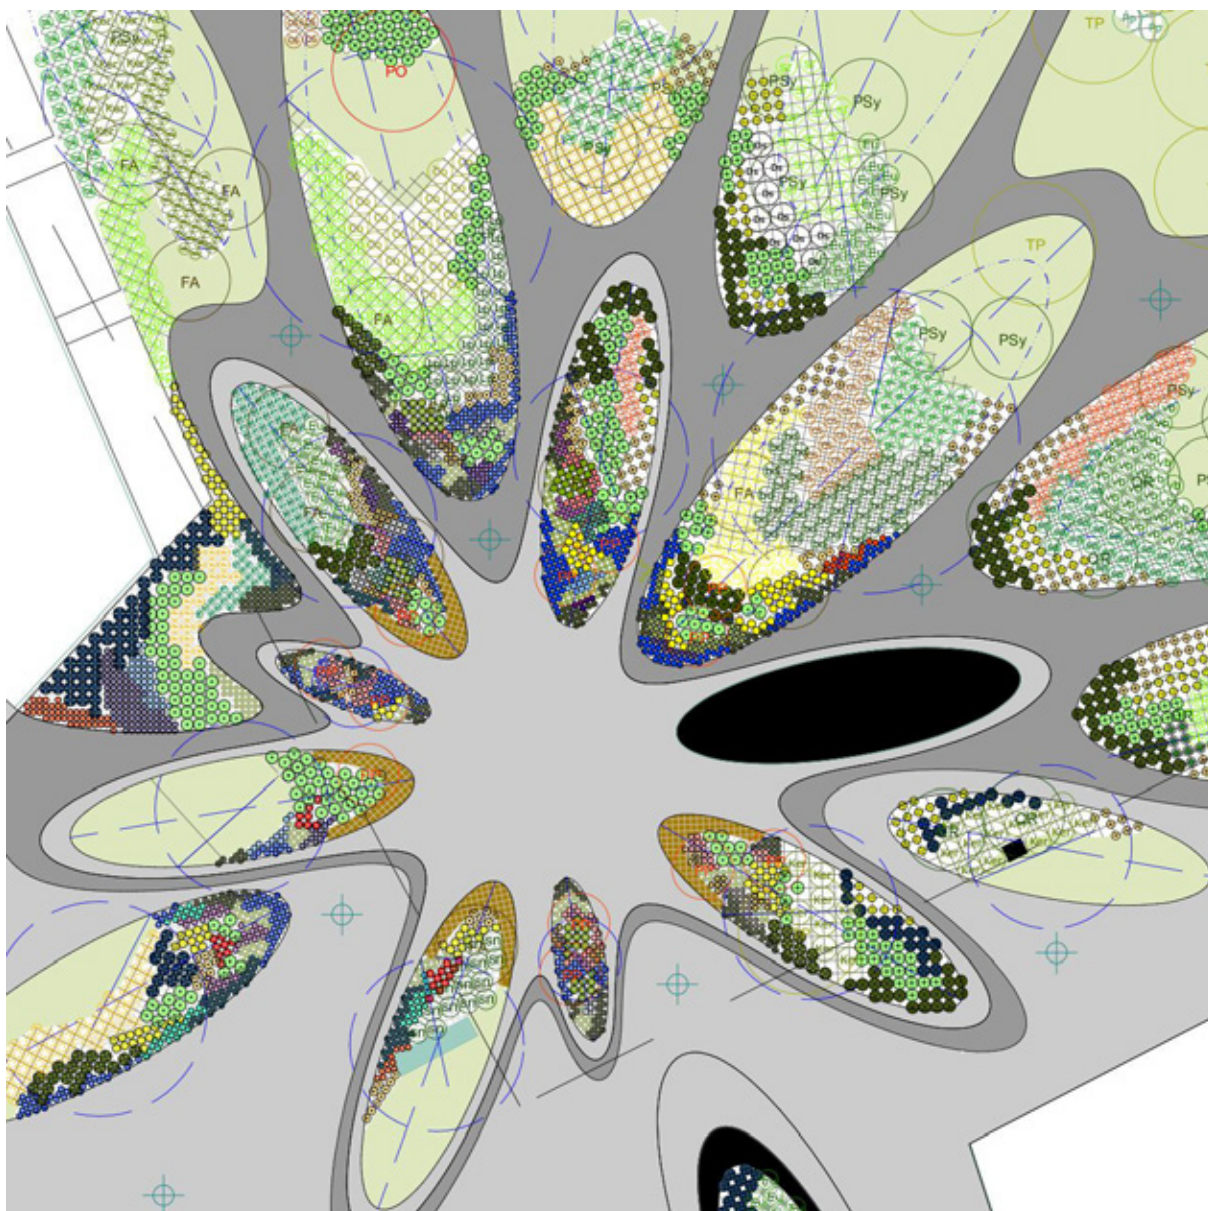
Extras din planul general de plantare, parte din proiectul de amenajare specifică
